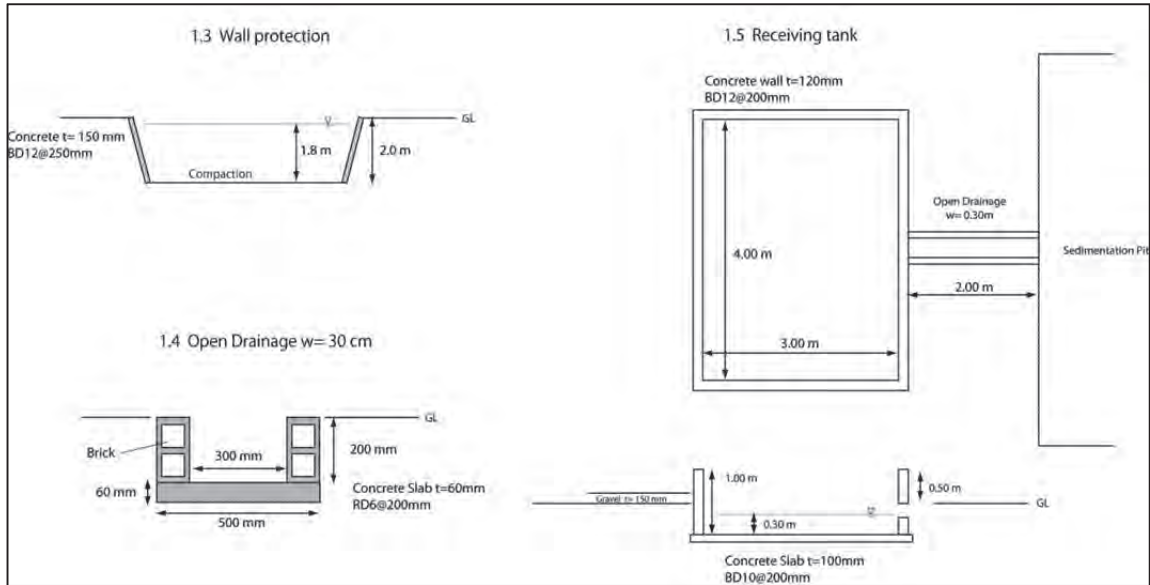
し尿浄化槽汚泥の処理施設の断面図
